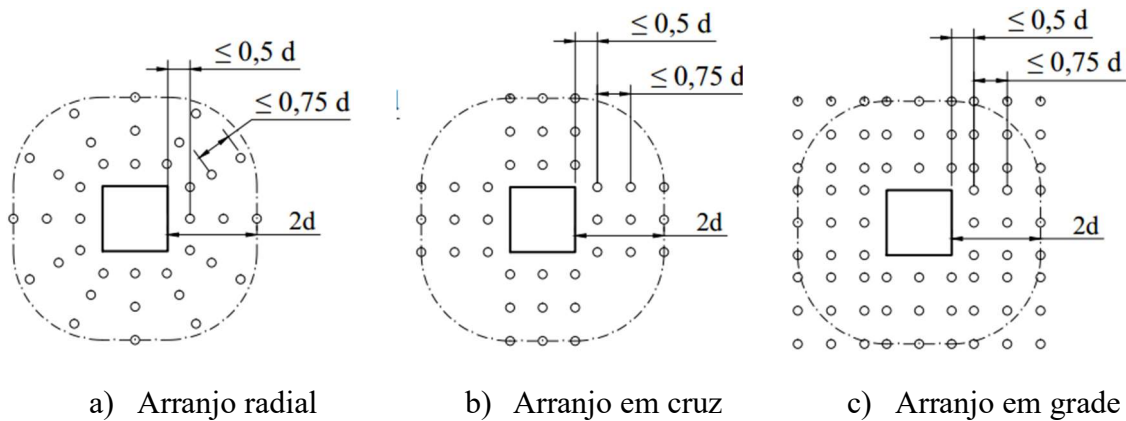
Especificações para posicionamento em planta da armadura de cisalhamento segundo a NBR 6118
